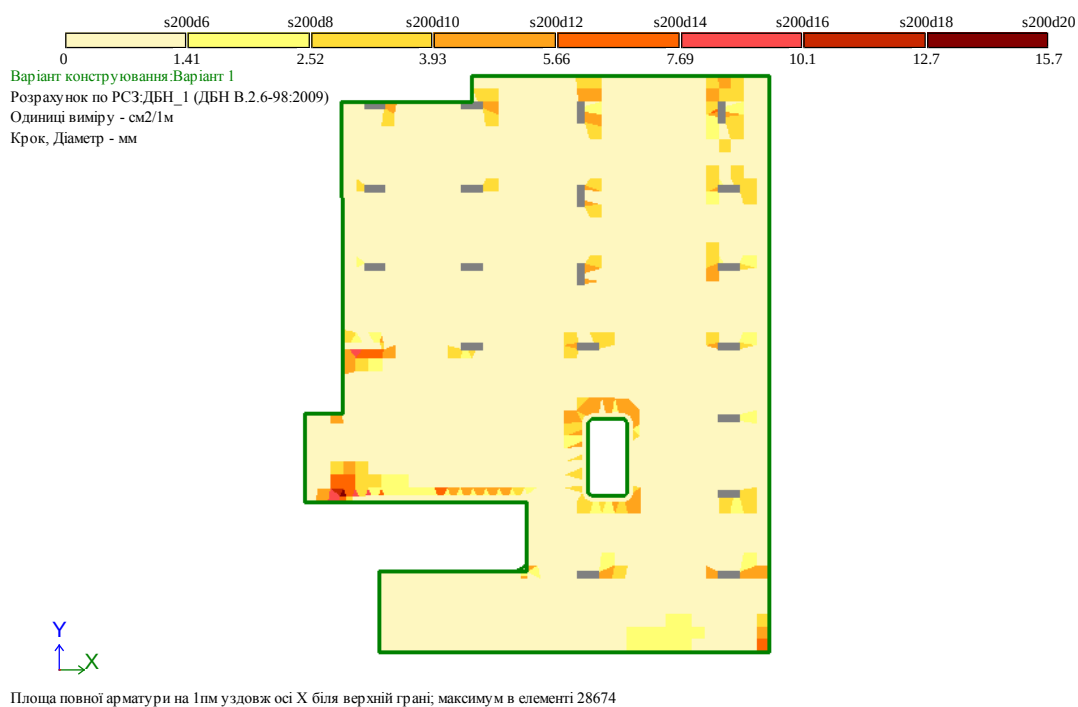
Армування плити перекриття типового поверху половини будівлі (верхня арматура в напрямку осі X)
